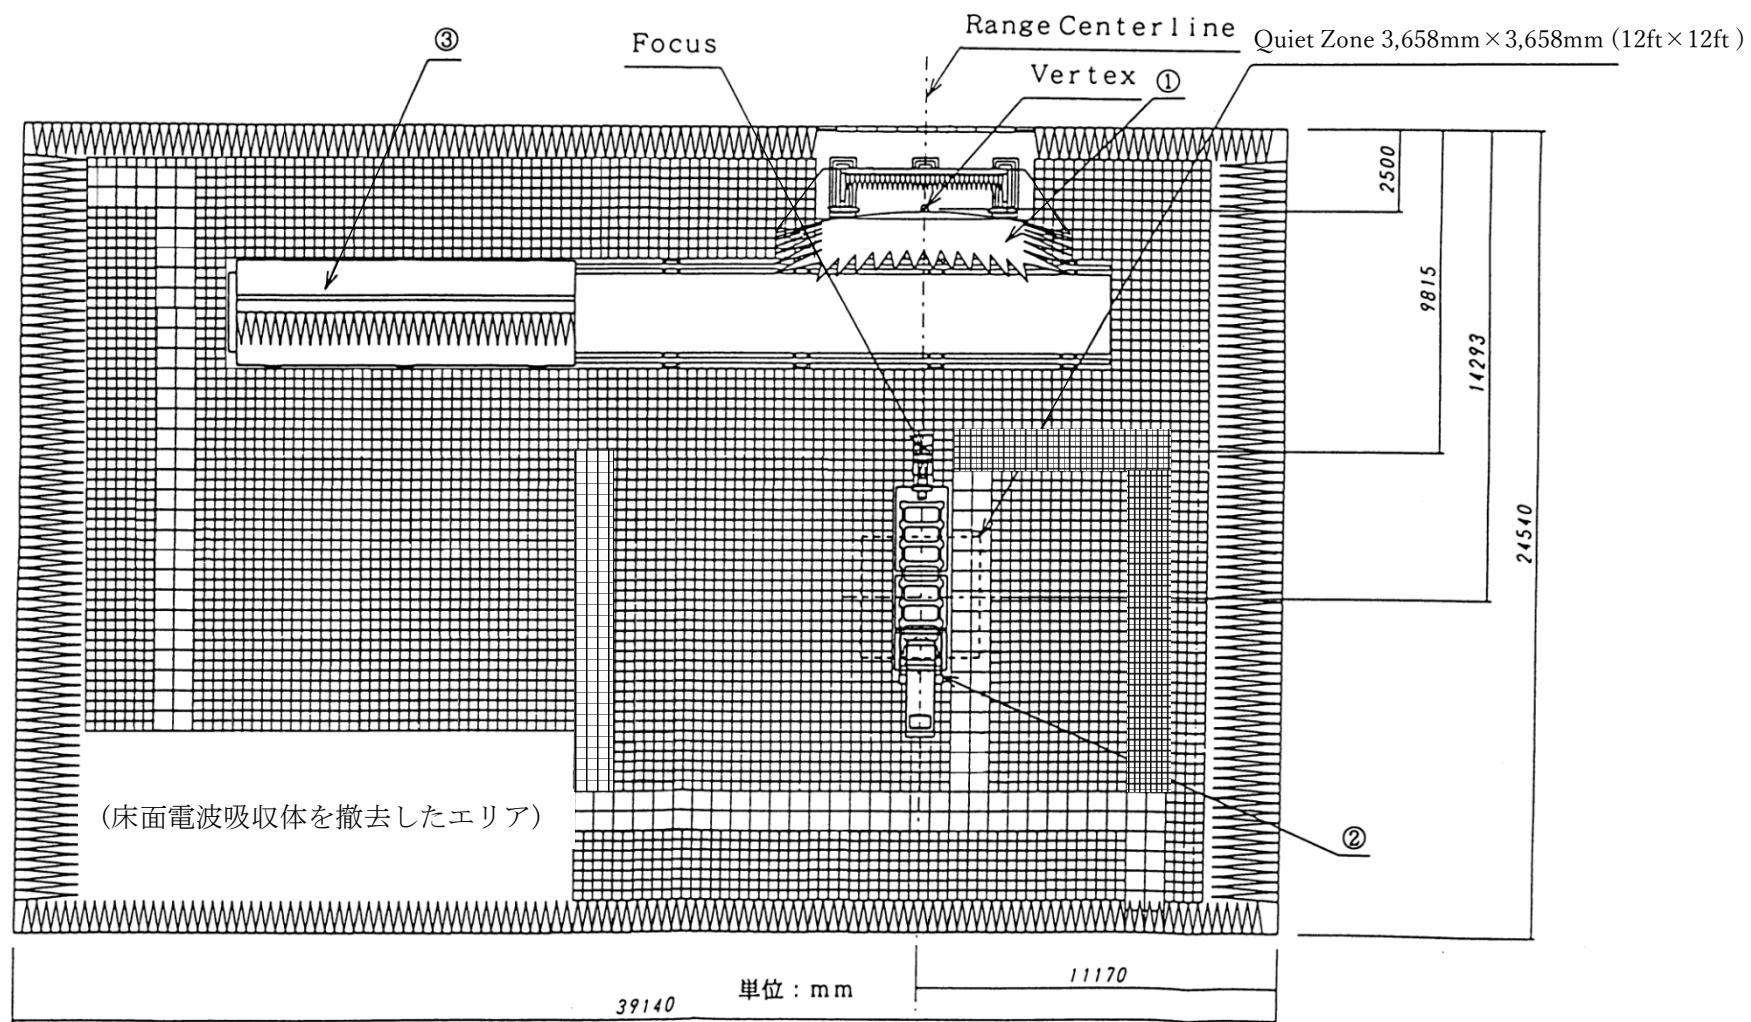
コンパクトレンジシステム構成図 (平面図)
